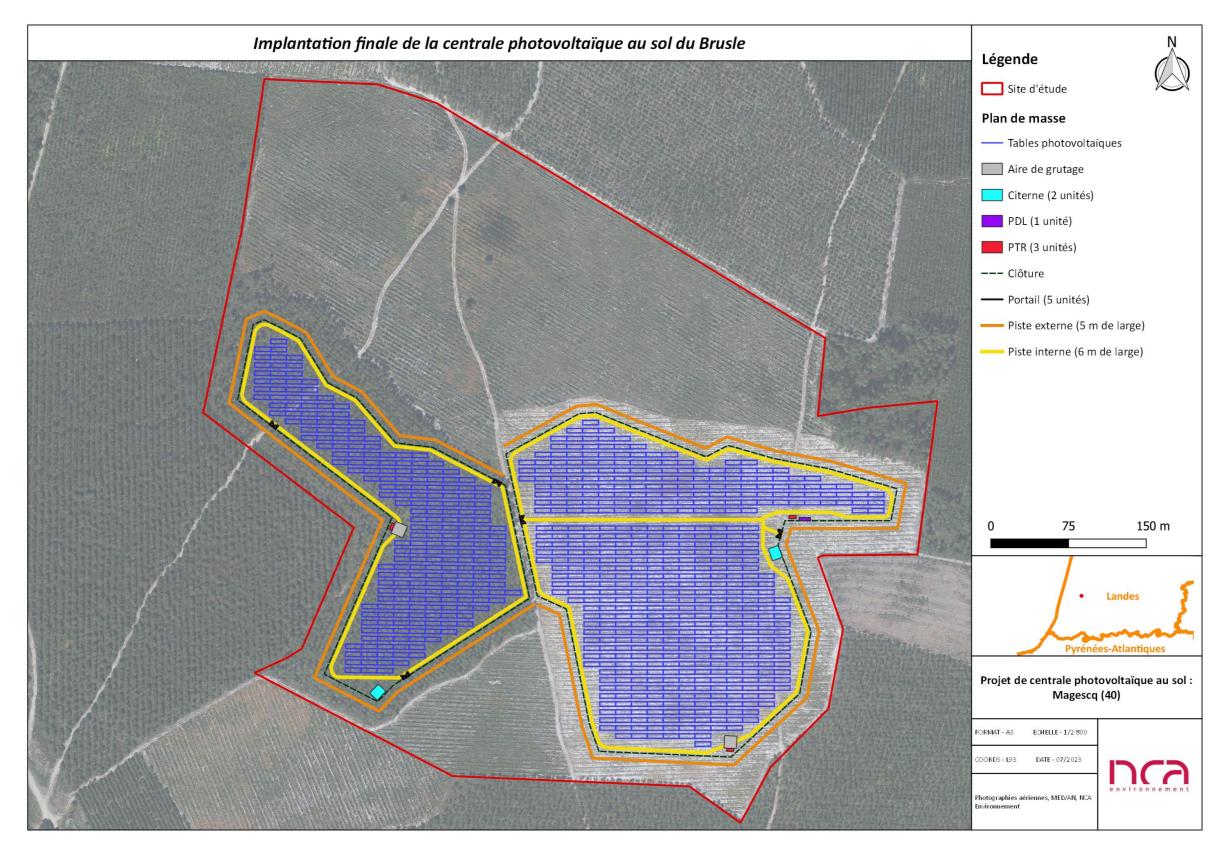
Implantation finale de la centrale photovoltaïque au sol du Brusle, sur la commune de Magescq
